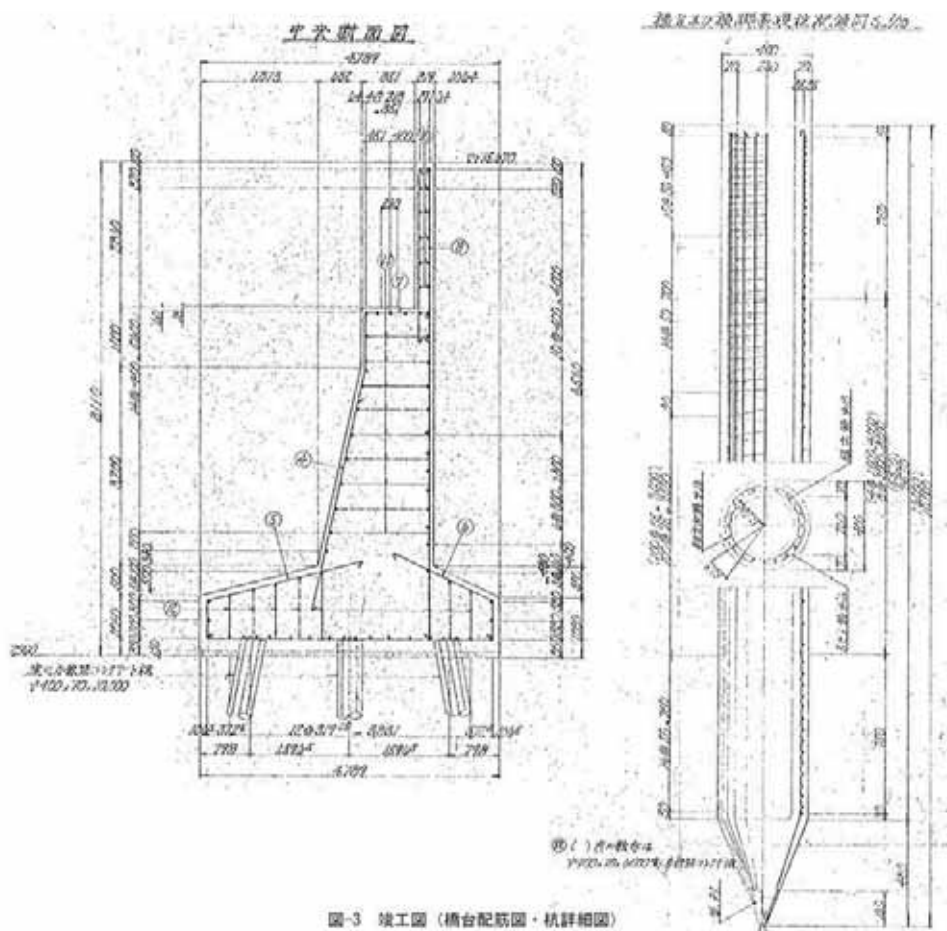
橋台および杭の配筋図(資料提供：宮城県)
